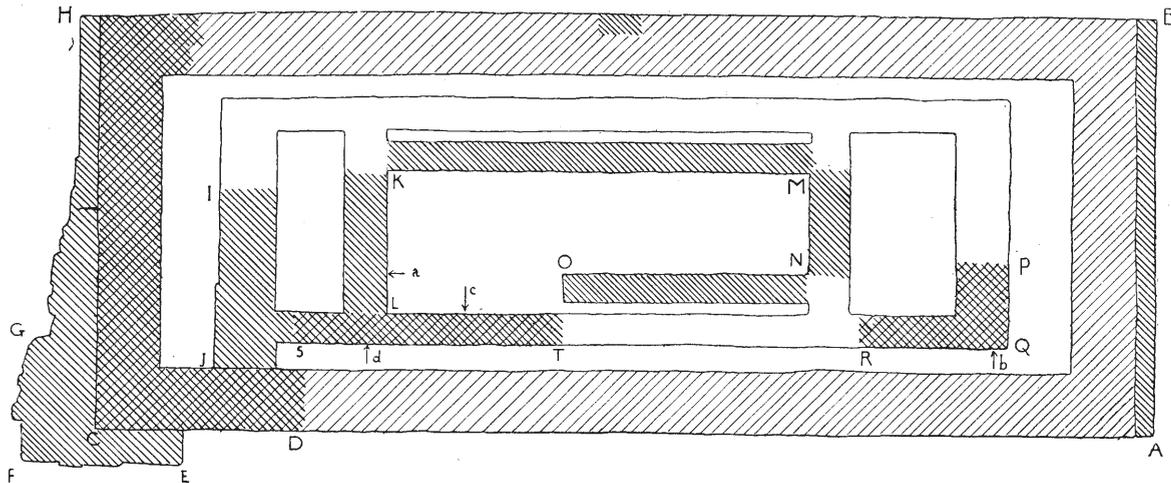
Plan schématique des fondations du temple (Largeur AB = 23^m.82).
